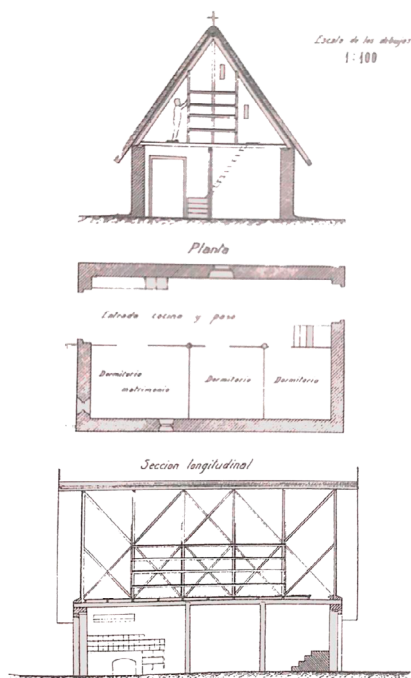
Planta, alzado y perfil de la distribución interna de una barraca.
